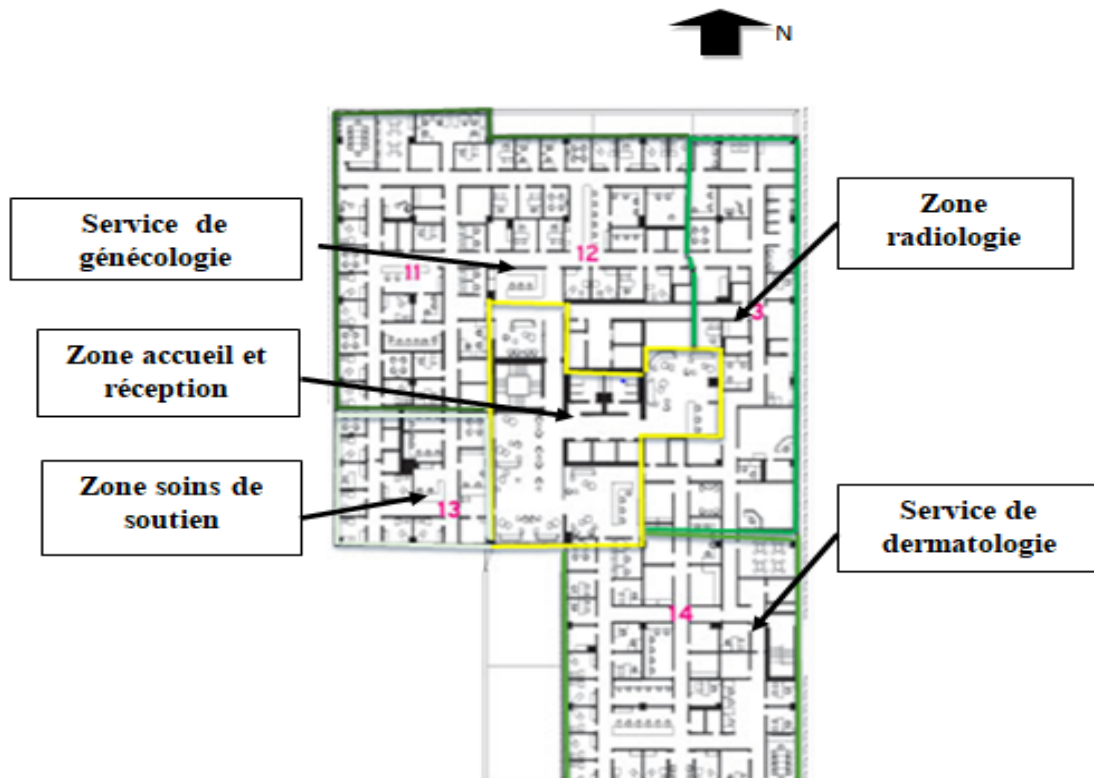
Plan 2^{ère} étage (www.archdialy.com)
